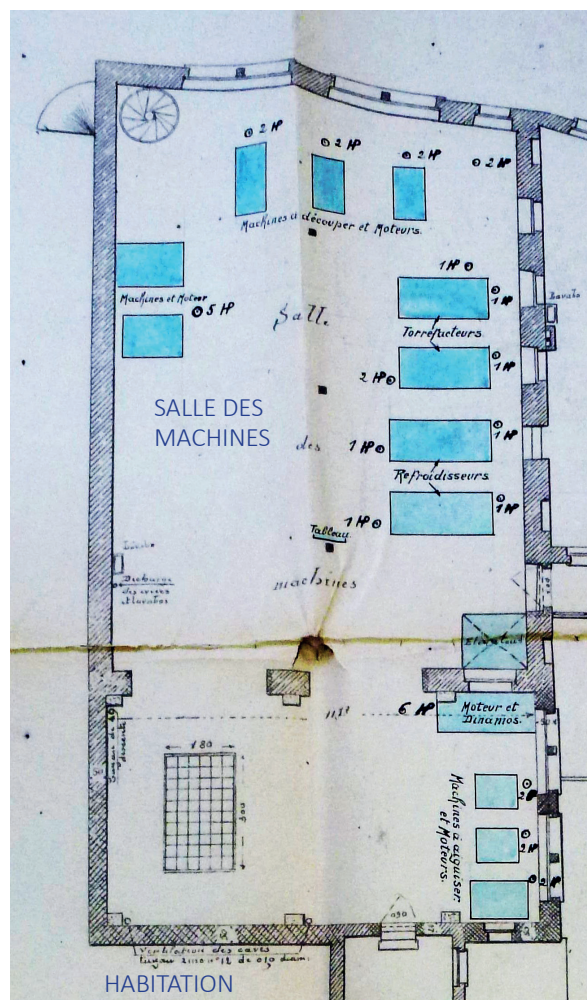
Plan du 1^{er} étage de la manufacture Doize
